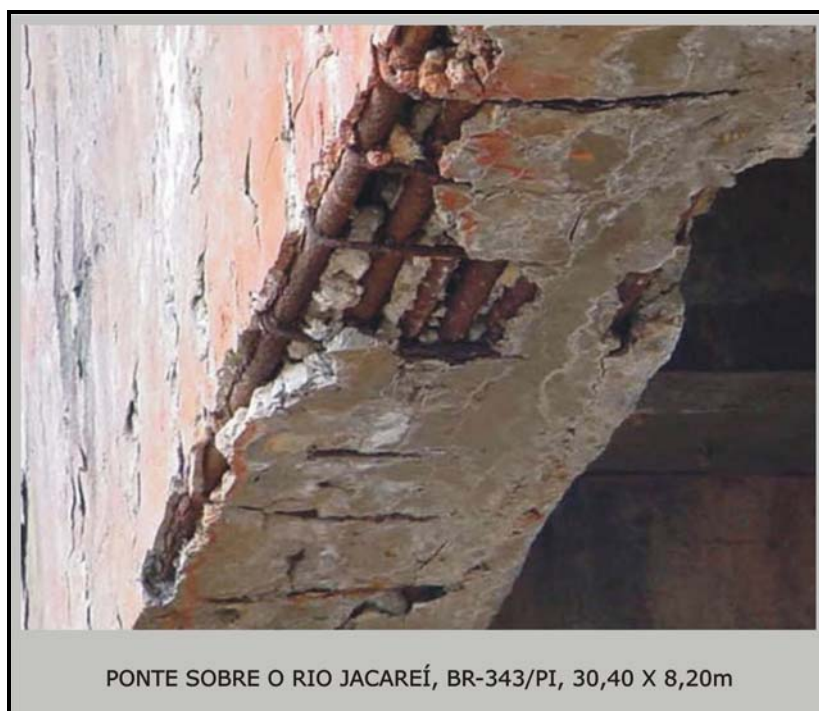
Viga principal com concreto deslocado, vazios de concretagem e corrosão de armaduras aparentes
